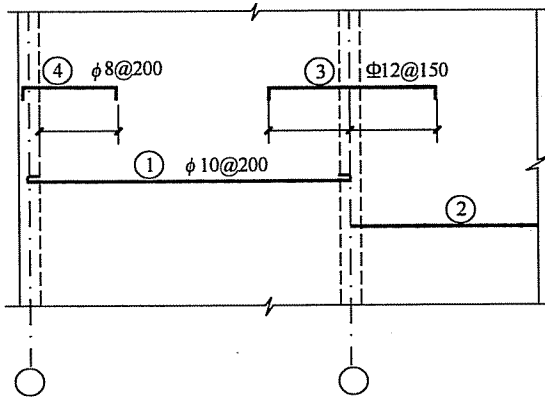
钢筋在楼板配筋图中的表示方法
